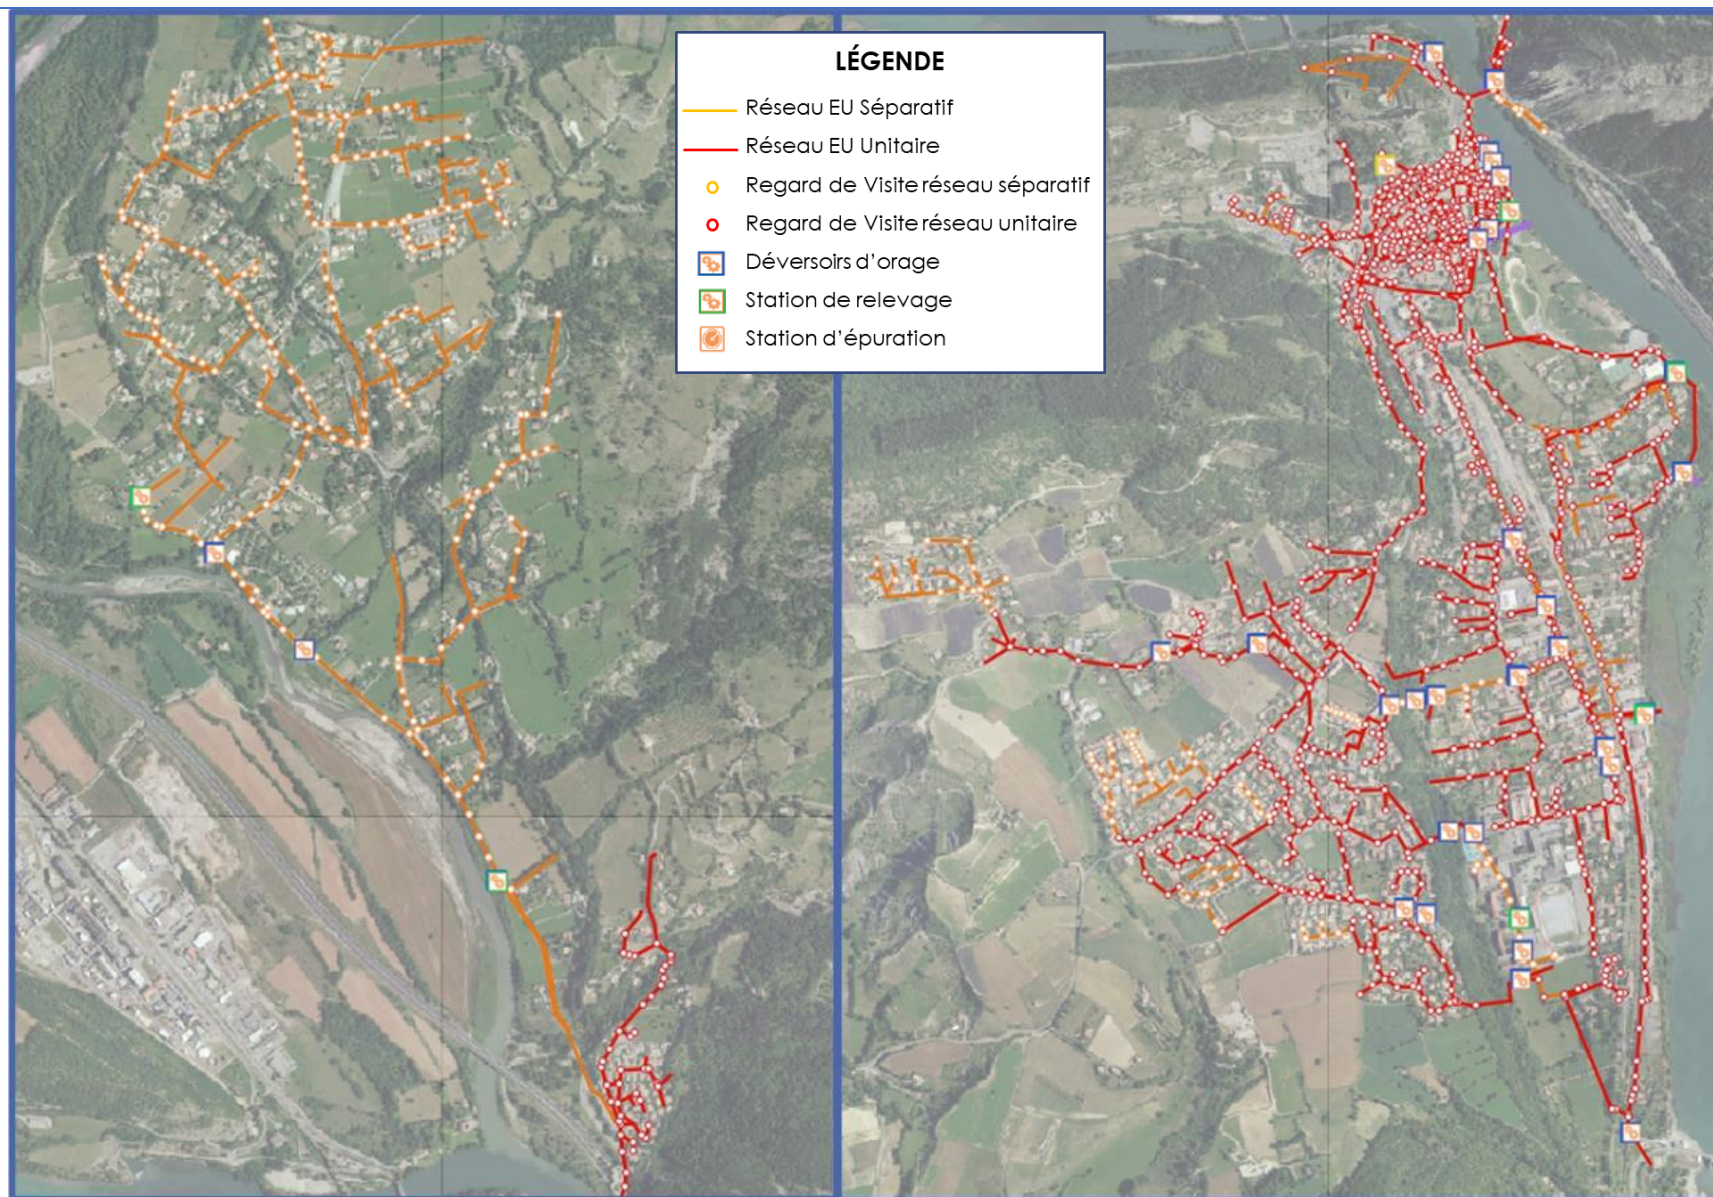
Plan du réseau d'assainissement de SAINT-LAZARE
